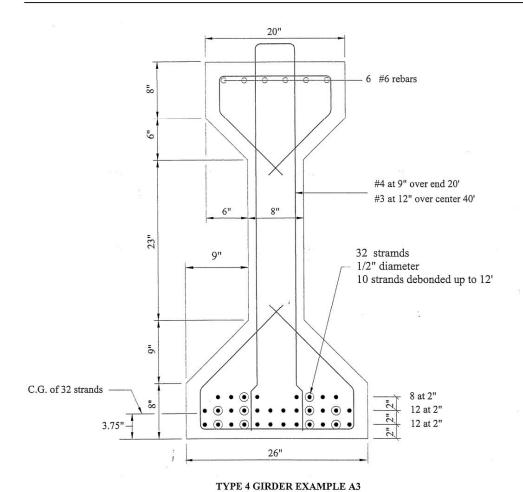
Sección transversal: viga interior Viga en I tipo 4 AASHTO
